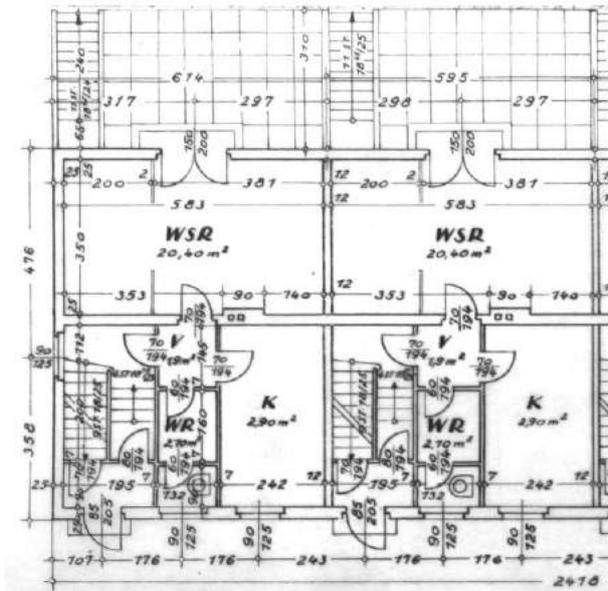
Erdgeschoss Wohnungsgrundriss Type III
